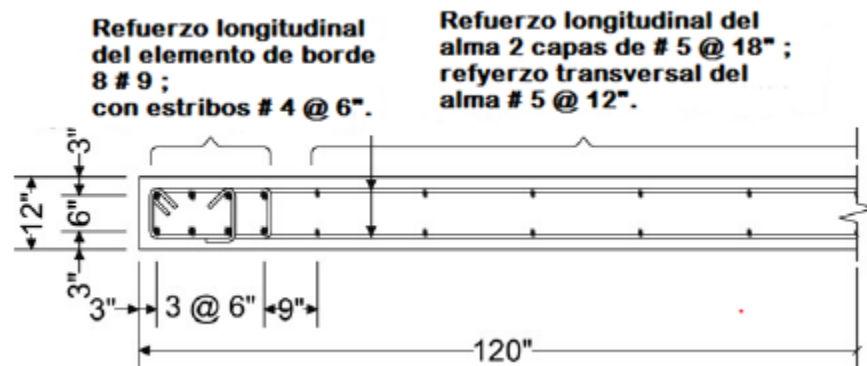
Geometría y detallado del refuerzo del muro W1, adaptado de [7].
